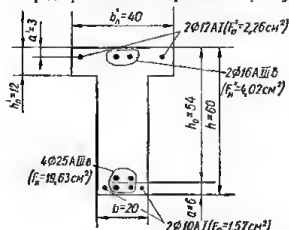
Схема таврового сечения предварительно напряженной железобетонной балки.
